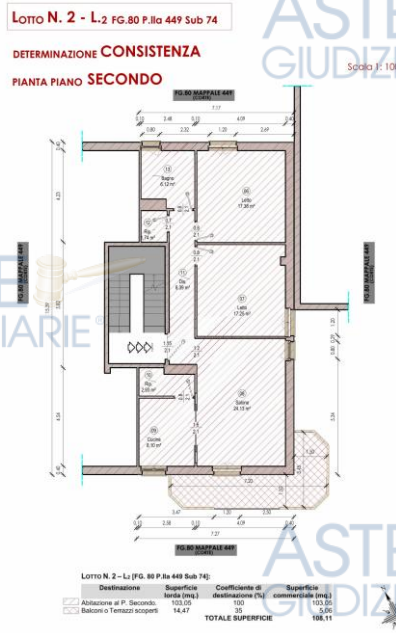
Determinazione consistenza Lotto L₂ (ALL. 11).
